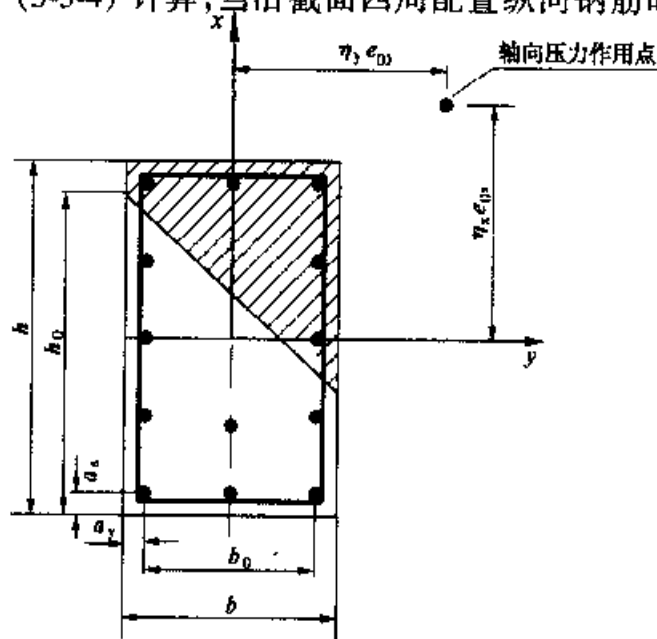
钢筋混凝土双向偏心受压构件截面
